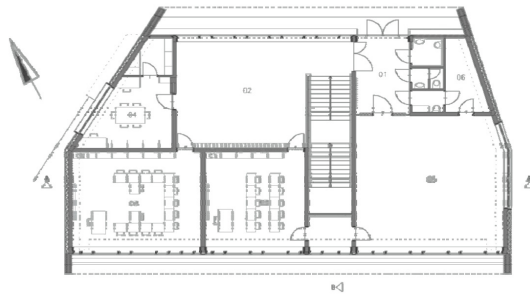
Pianta piano secondo; Fonte: A. Troi, et. al., 2009;
